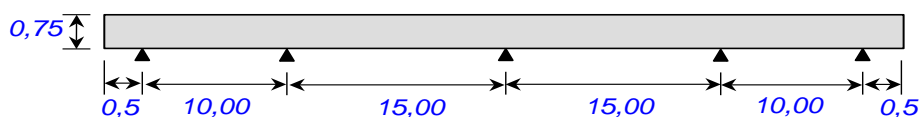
Coupe longitudinale biaisée de l'ouvrage
